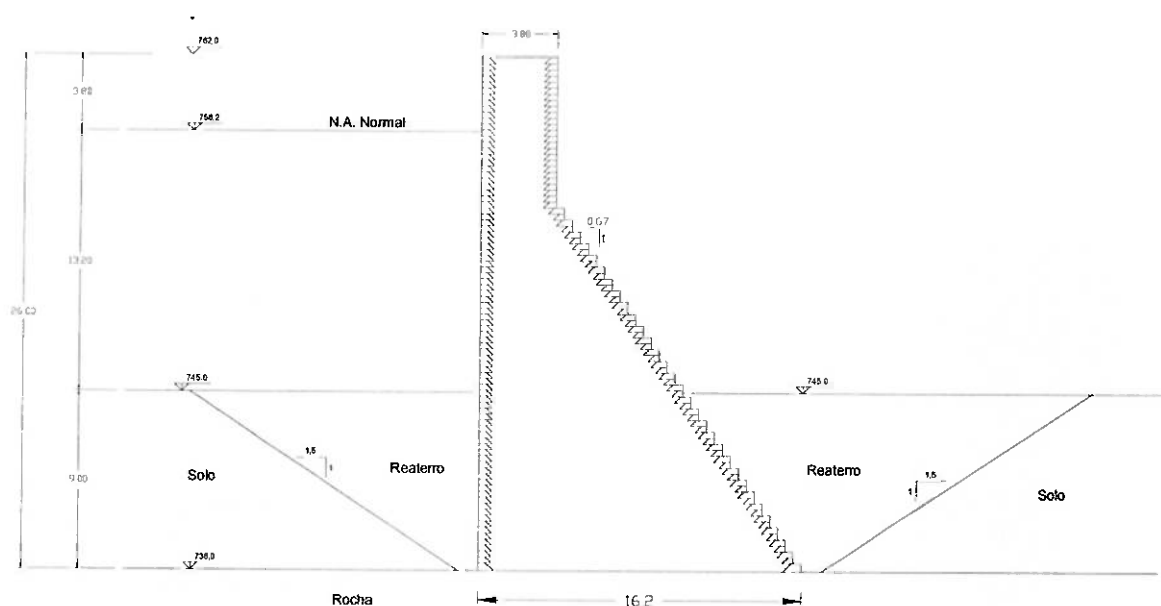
Estrutura da Barragem – Seção transversal genérica
